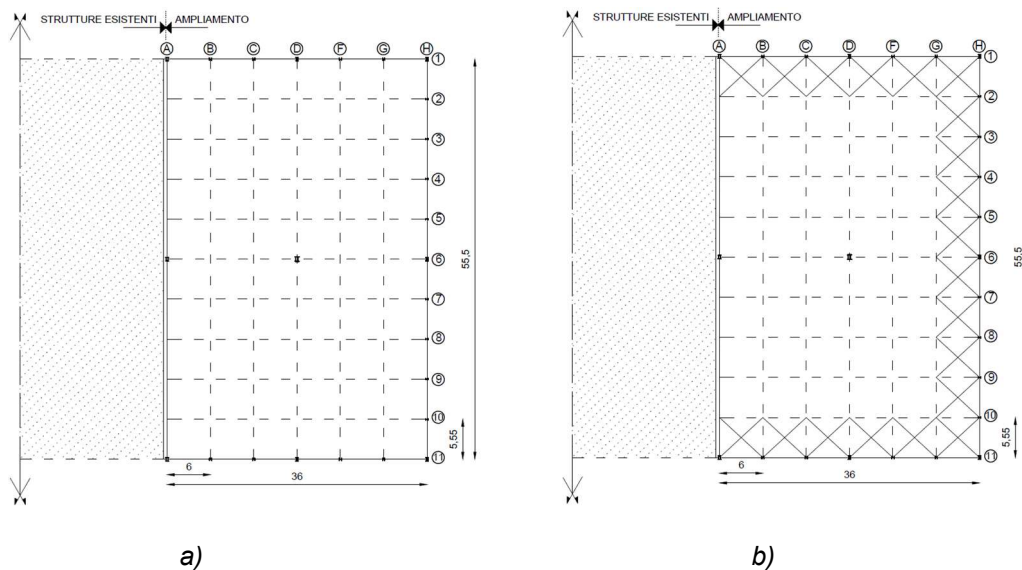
Pianta carpenterie quota +0m (a); +12.7 m b)
